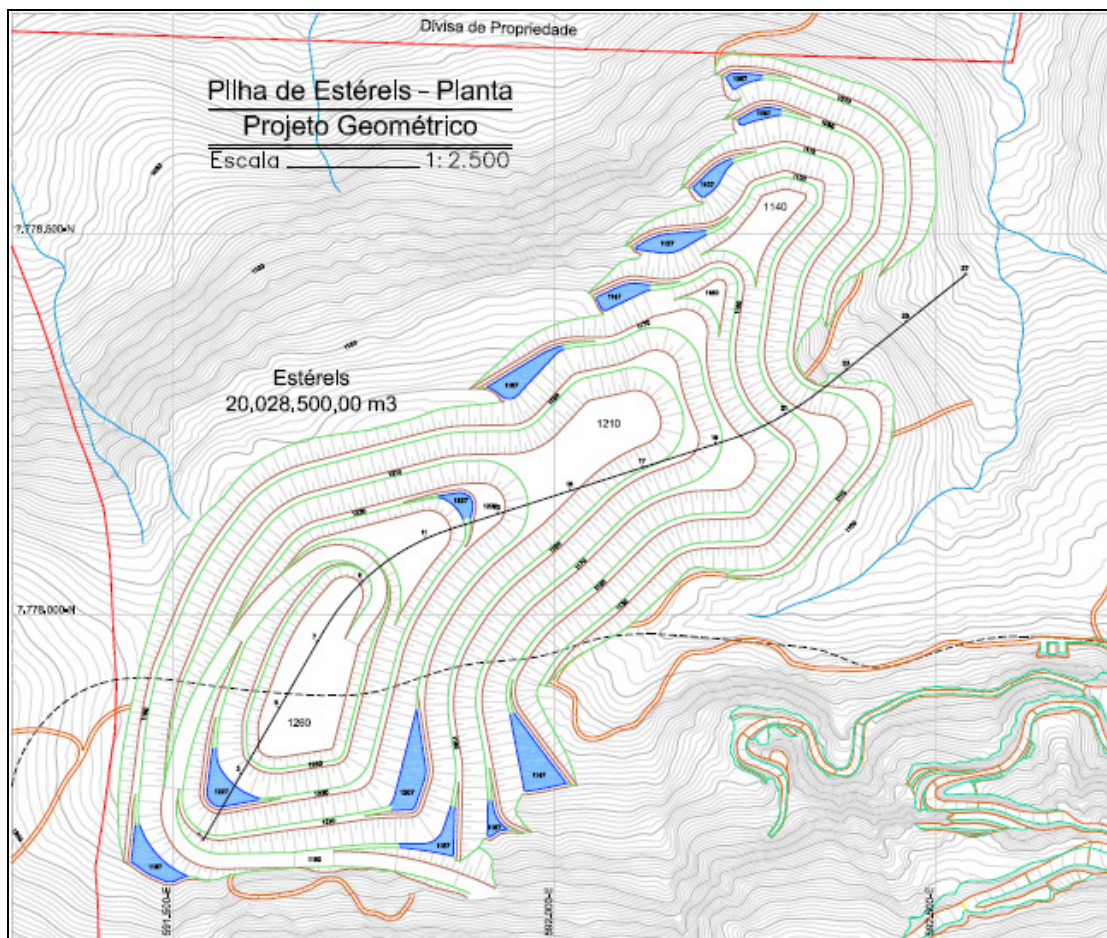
Planta. Fonte: Empreendedor, 2011.
